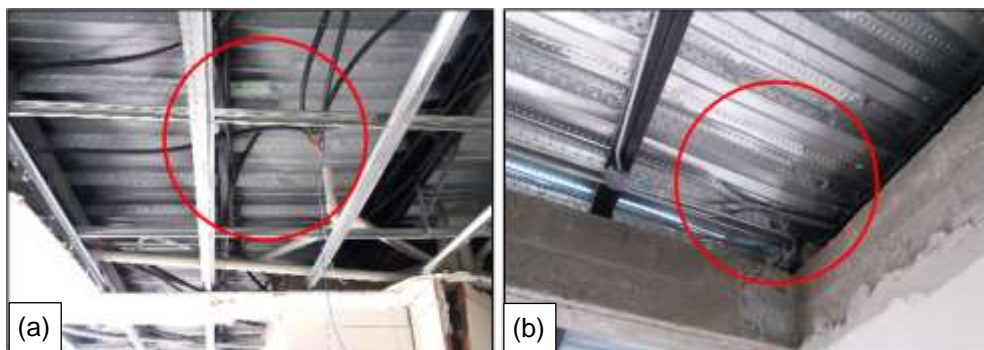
(a) y (b) Abolladura del *steel deck* y daños en la placa colaborante del hormigón.
